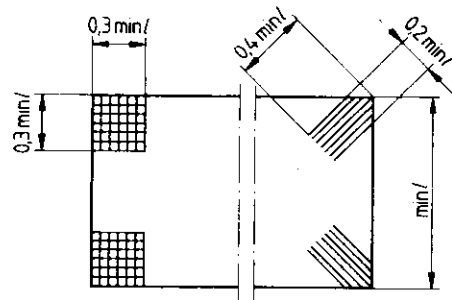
Rechtwinklige und schräge Eckbewehrung, Oberseite
